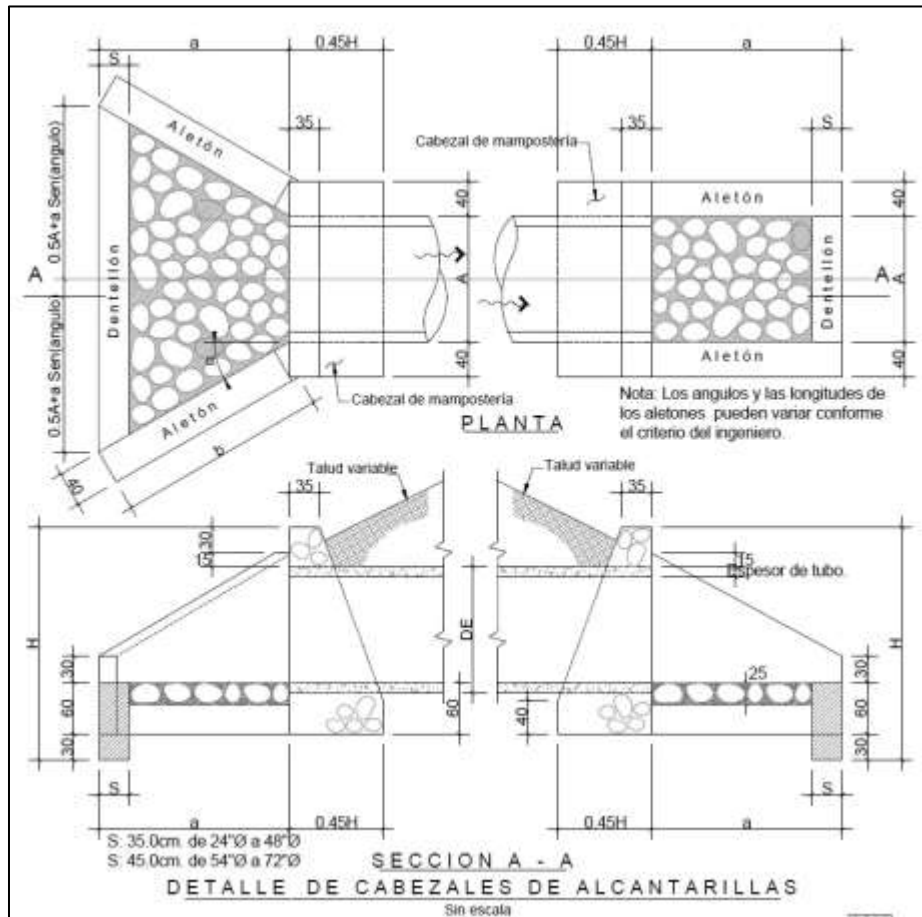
Esquema de Alcantarilla a emplear en obras de drenaje menor
